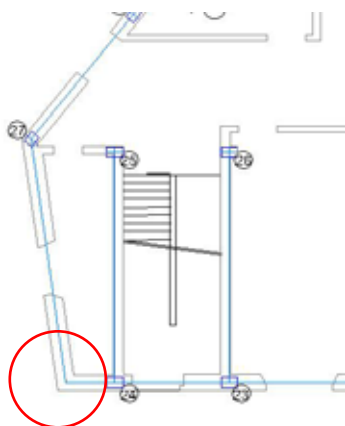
Piano terra cemento armato – angolo Sud-Ovest
